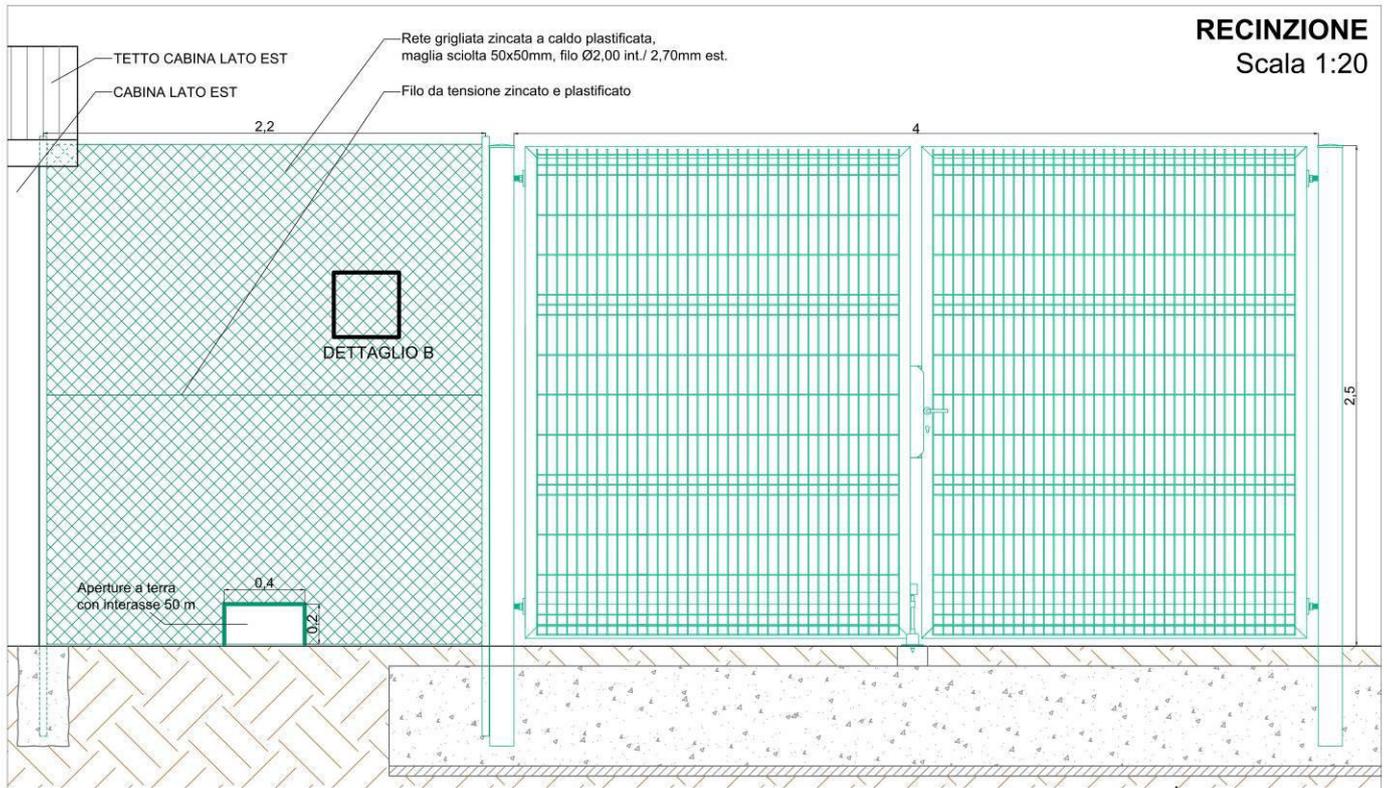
Stralcio della tavola di progetto “Recinzione e cancello” (dettaglio varchi per piccola fauna).
